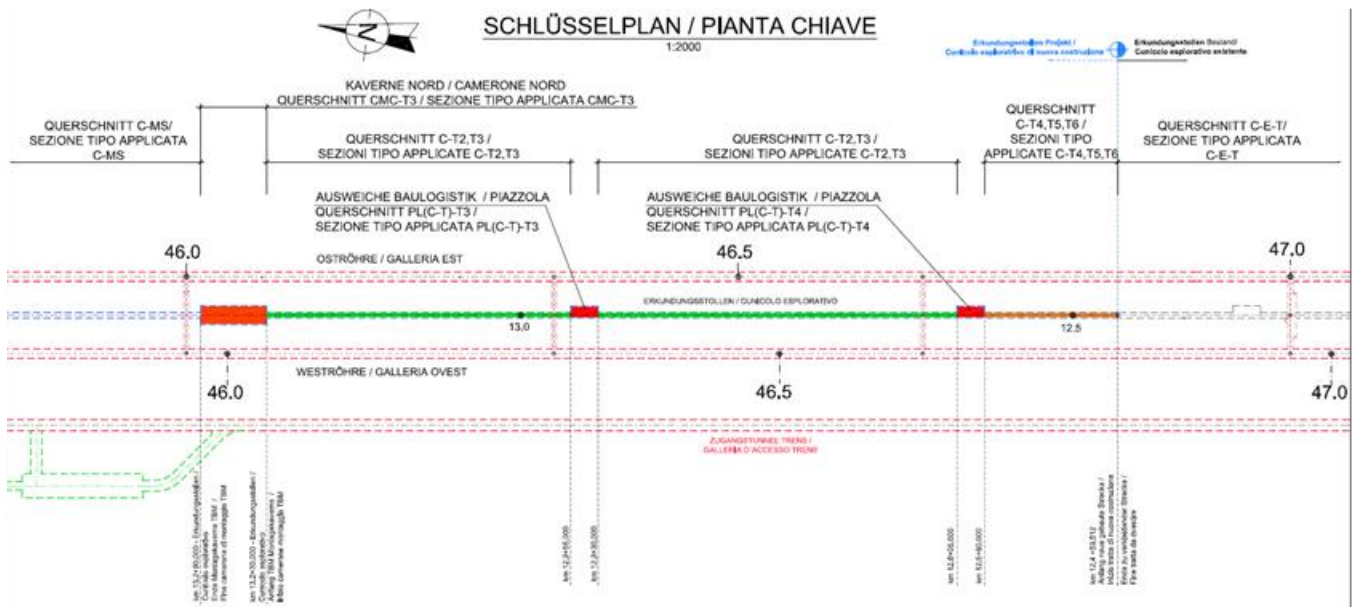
Planimetrisches Schema der konventionell vorzutreibenden Erkundungsstollenstrecke [105].
